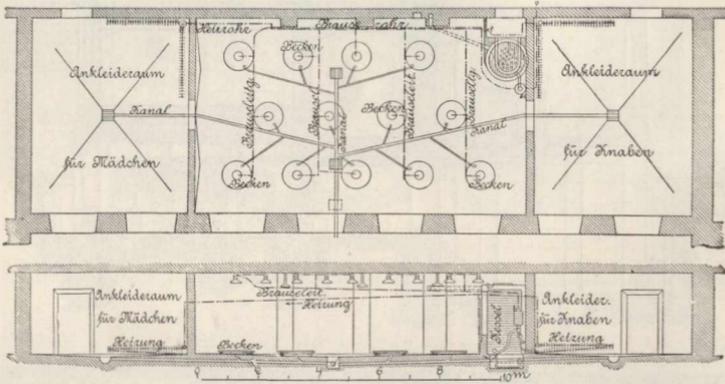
u. 5. Grundriß und Längsschnitt des Brausebades einer Bremer Volksschule.
